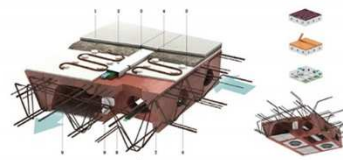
Esquema de propuesta tecnológica Holedeck para grandes naves en concreto.
